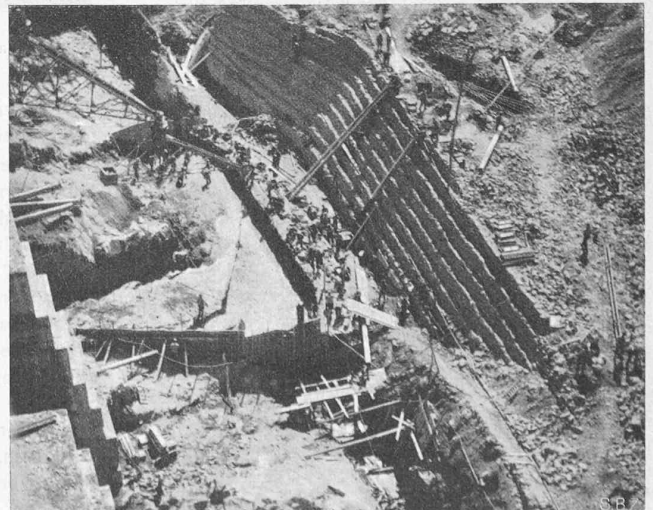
Betonieren des wasserseitigen Mauerfundamentes (3. Sept. 1933).
